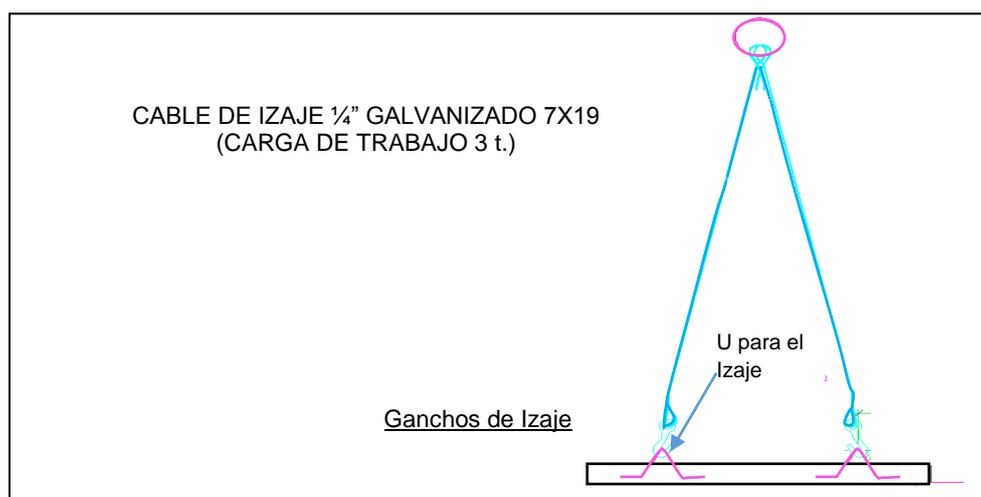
Detalle para el Izaje de Pre-losa lisa o sin tralicho
